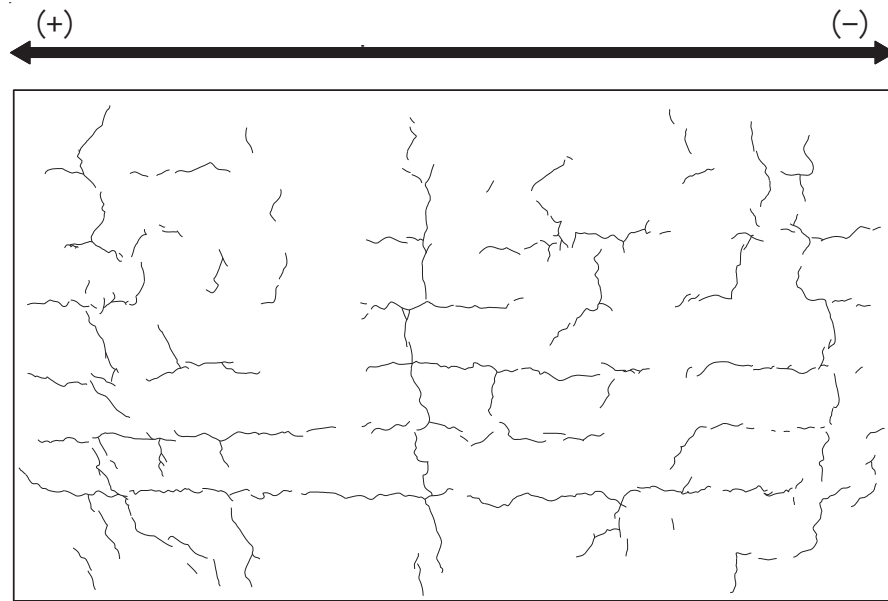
(1) 乾燥試験体 [2] 加力前におけるひび割れ図
